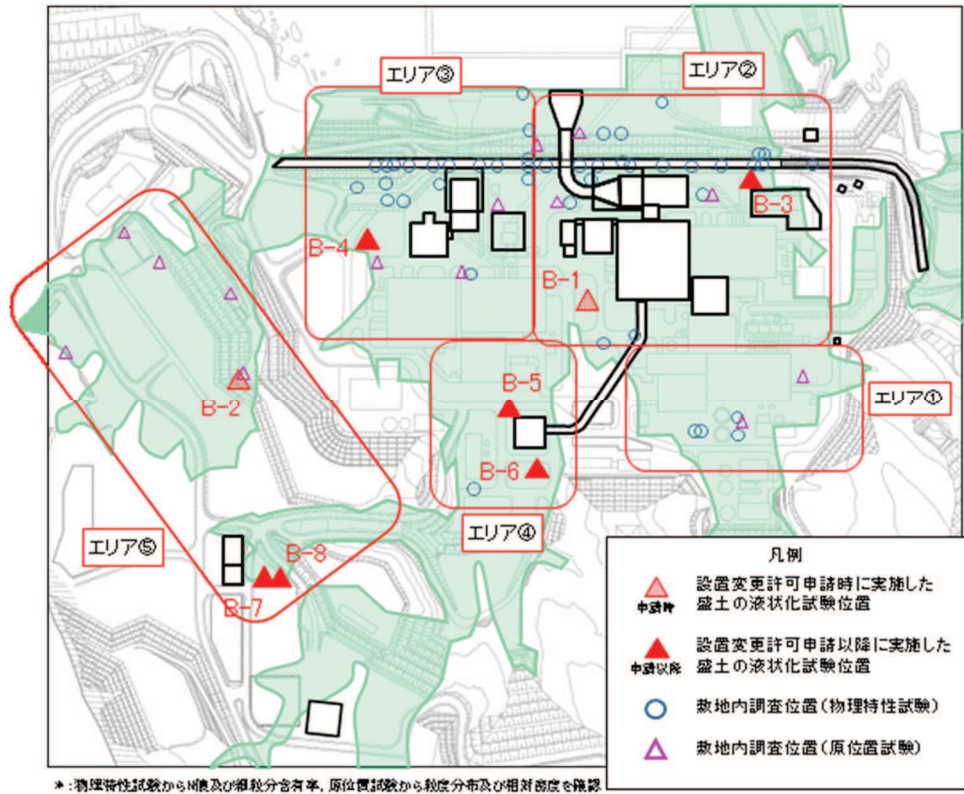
盛土の液状化強度試験位置及び敷地内調査位置の平面図
